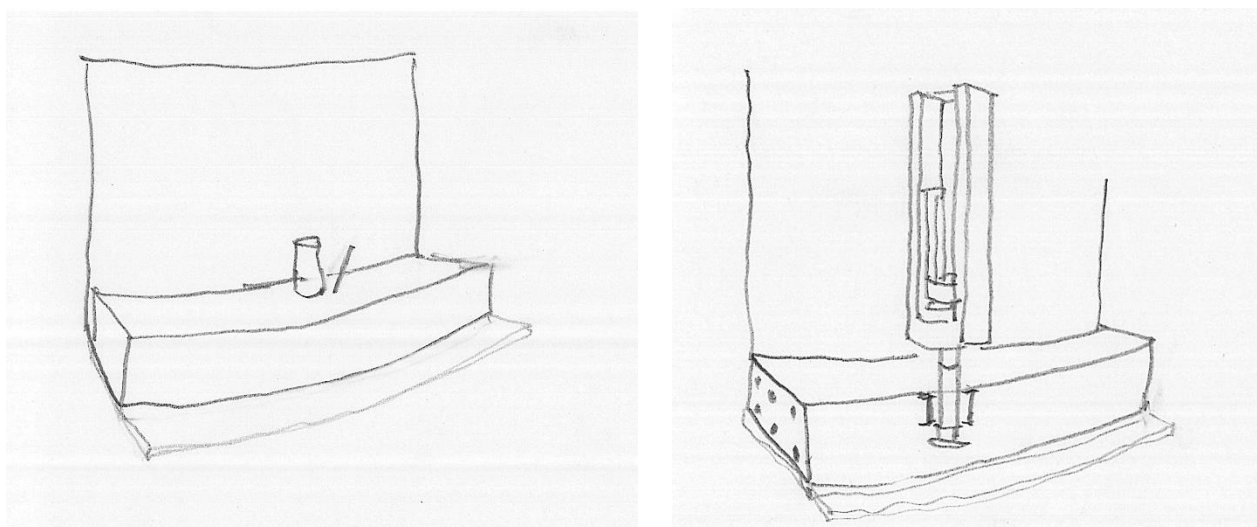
Fasi del consolidamento fondale: getto del cordolo di fondazione e inizio delle operazioni di infissione degli spezzoni di tubo in pressione nel terreno.
